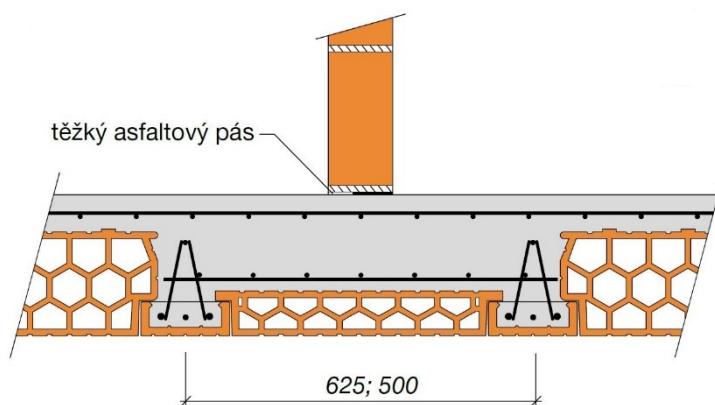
Betonáž připravené stropní konstrukce [33]
